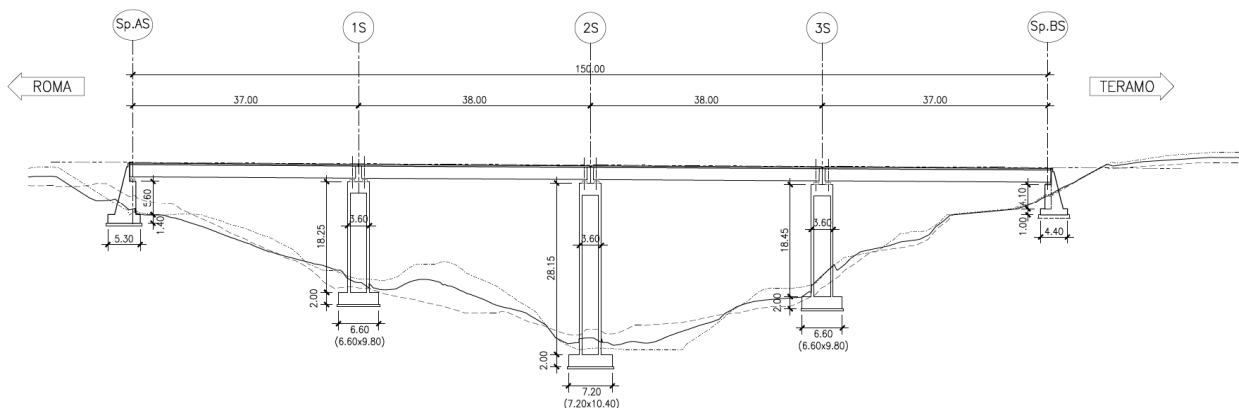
Prospetto viadotto Valle Orsara – Stato attuale
